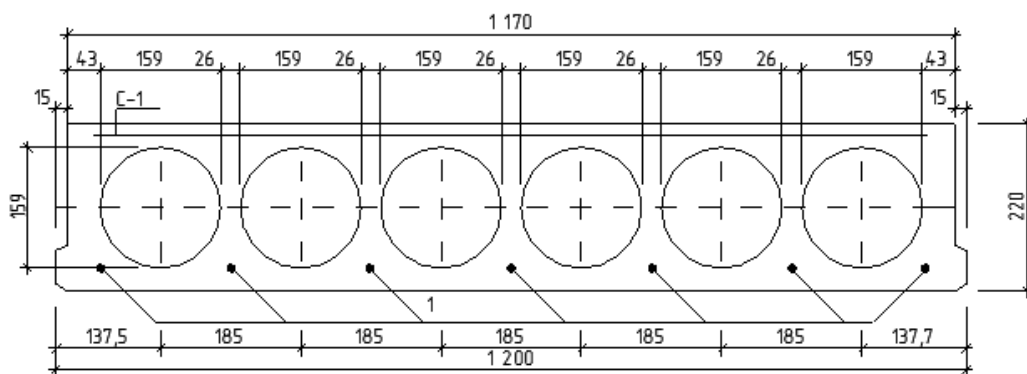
Поперечний переріз багатопустотної плити перекриття
